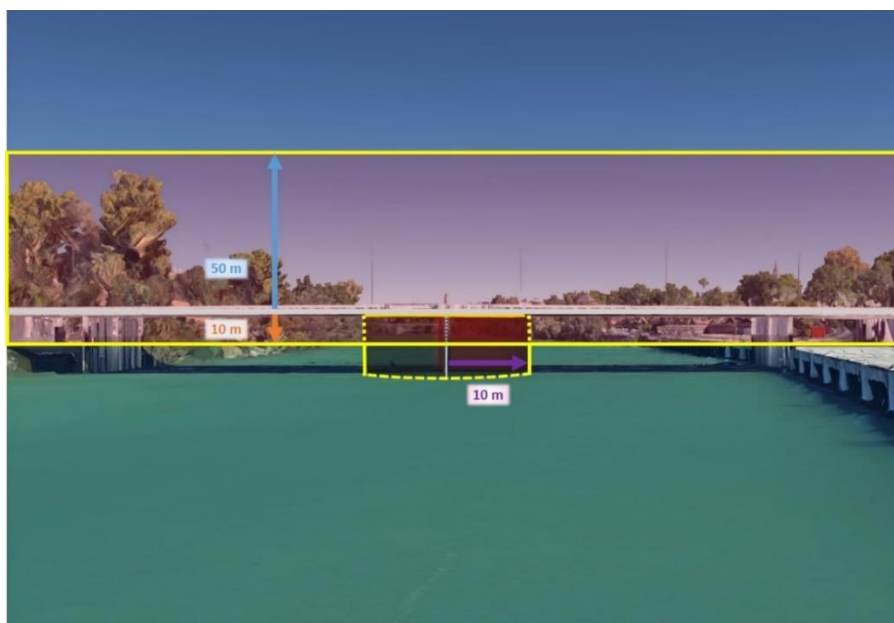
Infraestructura lineal con puente - Vista alzado
